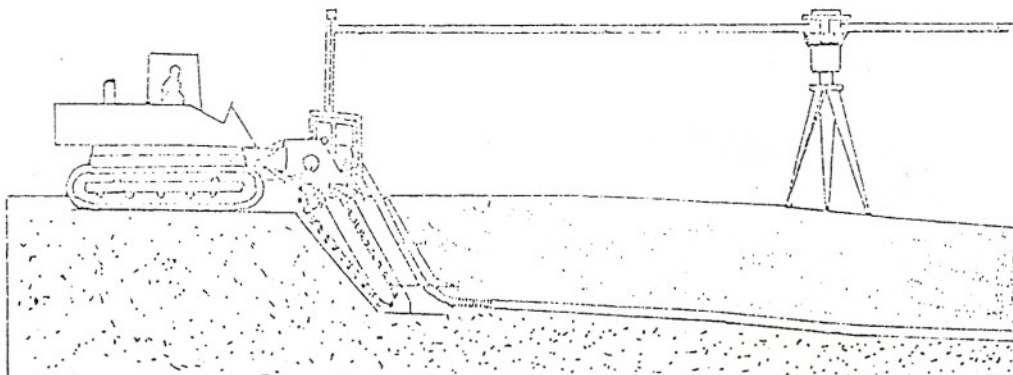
Guidage par laser rotatif de l'outil de pose.
